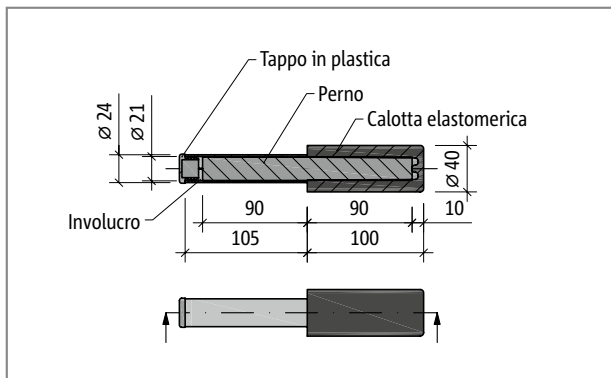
Schöck Tronsole® tipo D-H: pianta del prodotto
